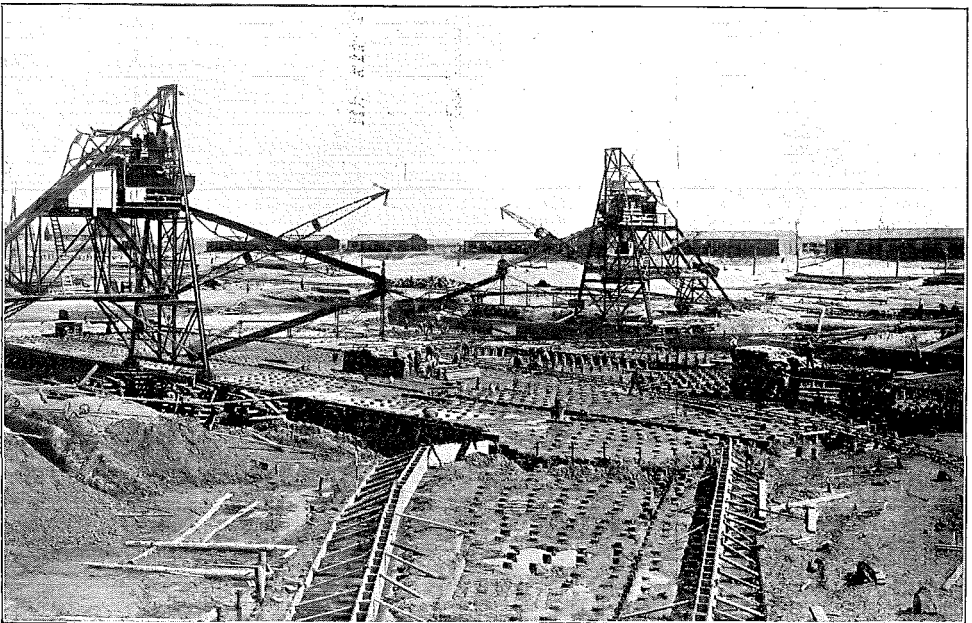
Uitwateringssluisbouw op het Cornwerderzand. Paalfundering en betonmolens.
